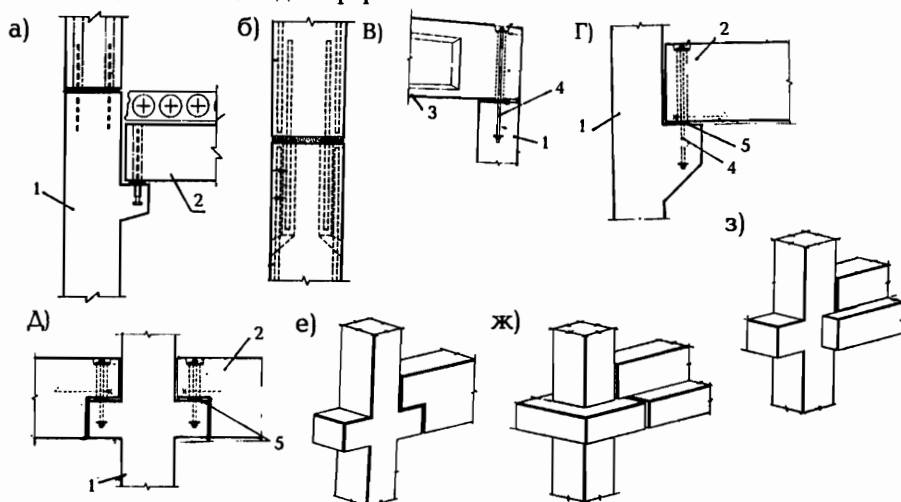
Стыки сборных конструкций многоэтажных каркасных зданий: а, б, в, г – колонн, ригелей, кровельных балок; 1 – колонна; 2 – ригель; 3 – кровельная балка; 4 – металлический анкер с резьбой; 5 – резино-металлическая прокладка; е, ж, з – стыки колонн с ригелями
